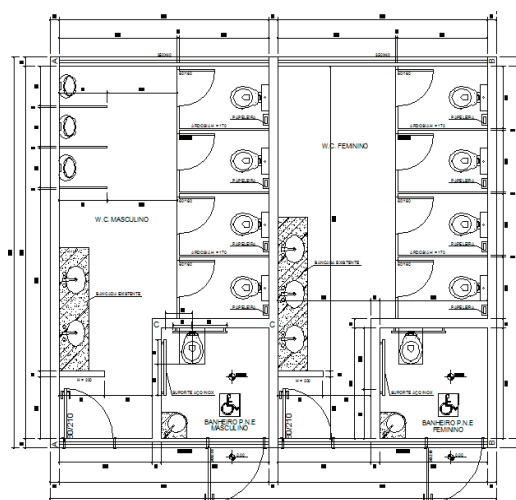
Planta Baixa do Banheiro no Projeto Modificado Após o PQP
